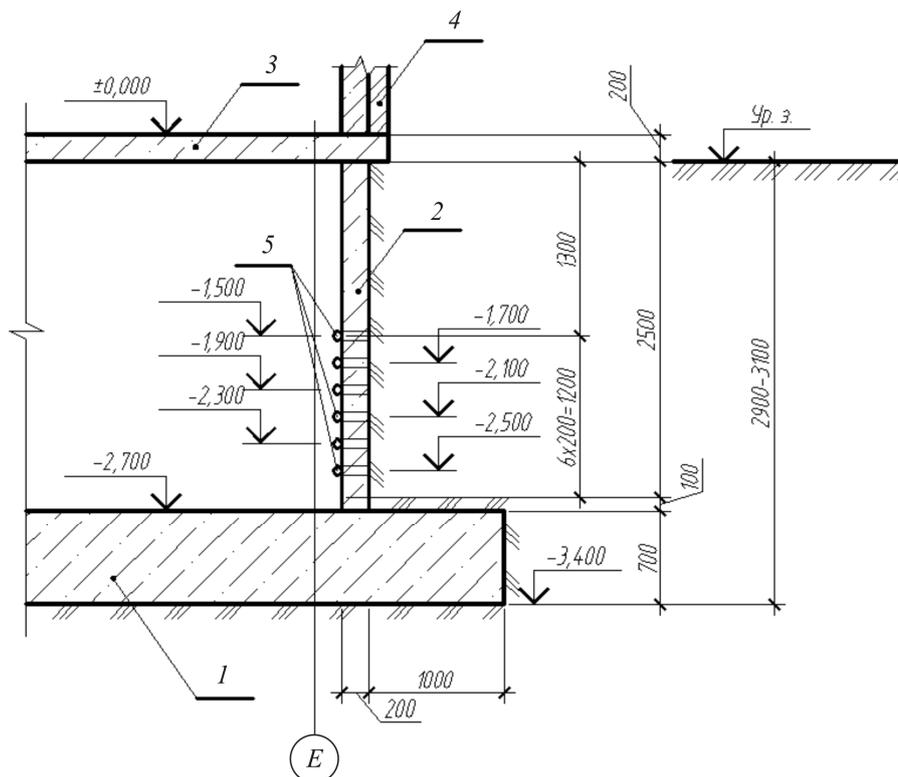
Схема устройства наблюдательных отверстий для оценки поступления подземной воды в подвальные помещения здания: 1 – фундаментная плита; 2 – наружная стена подвальной части здания; 3 – плита перекрытия подвала, отм. $\pm 0,000$; 4 – наружная стена первого этажа; 5 – наблюдательные отверстия
